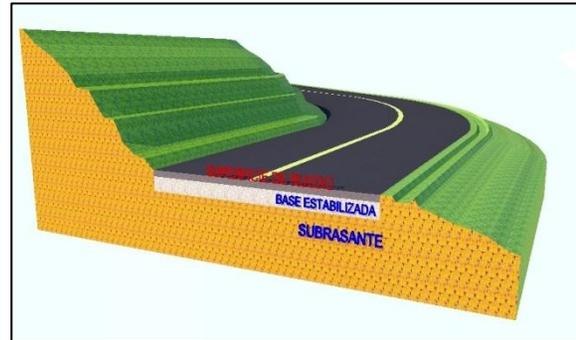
Estructura pavimento semi-rígido (Autor, 2012)
